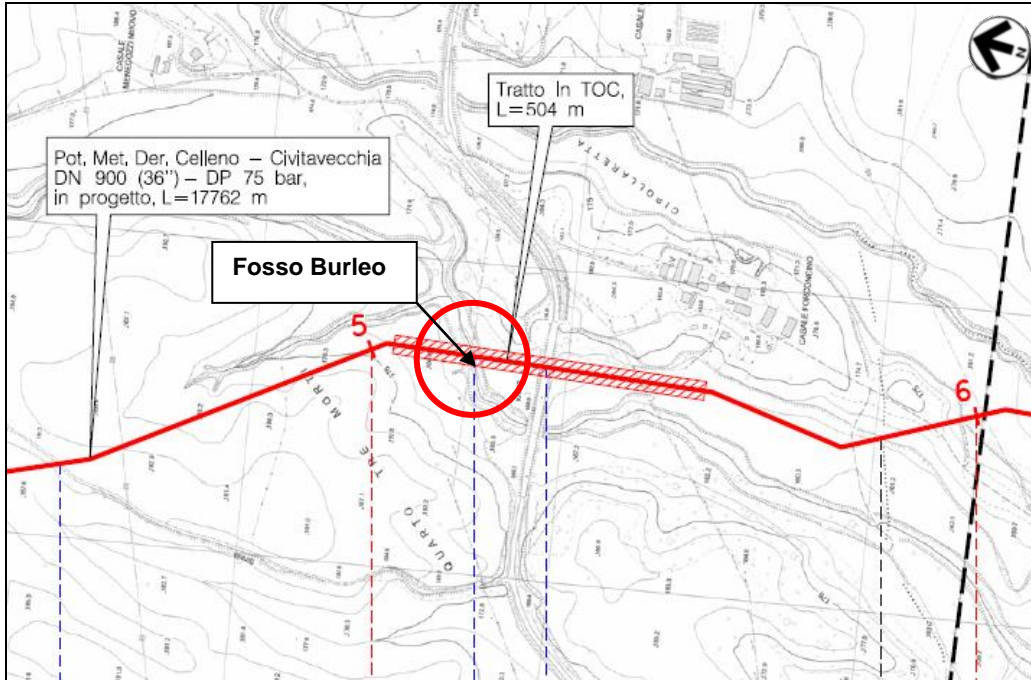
/B – Stralcio planimetrico con localizzazione dell’attraversamento (progr. Km 5+167)
